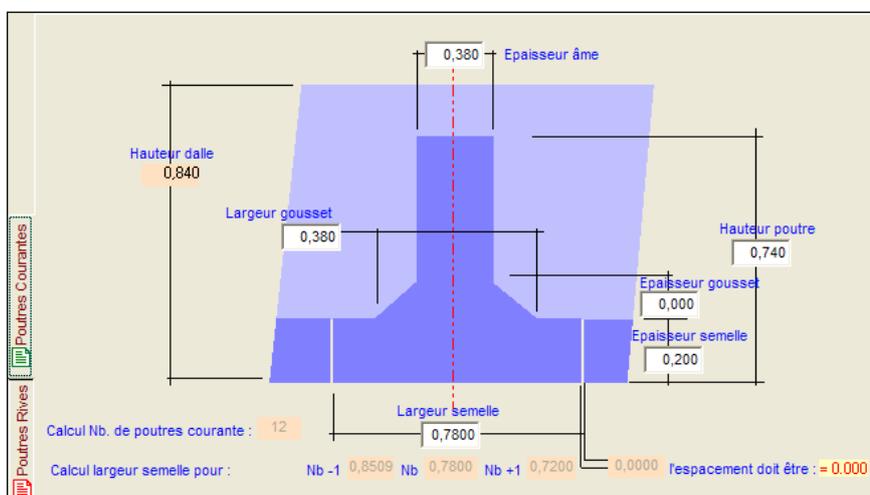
Géométrie des poutres centrales (ouvrage n°2)
